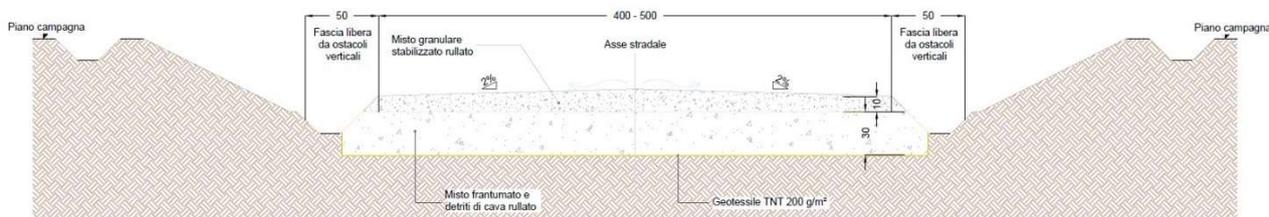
Sezione tipo pista di impianto in trincea; misure in centimetri
